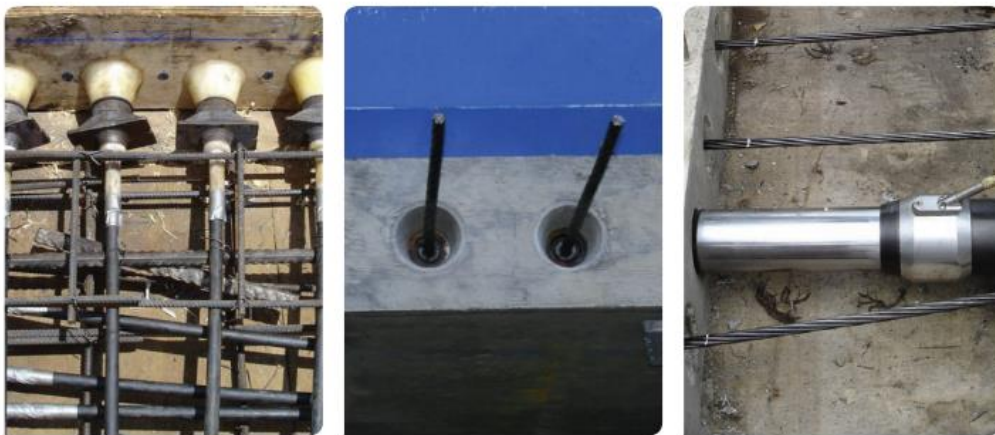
Detalle de torón en sistema postensado no adherido. Fuente: CCL
